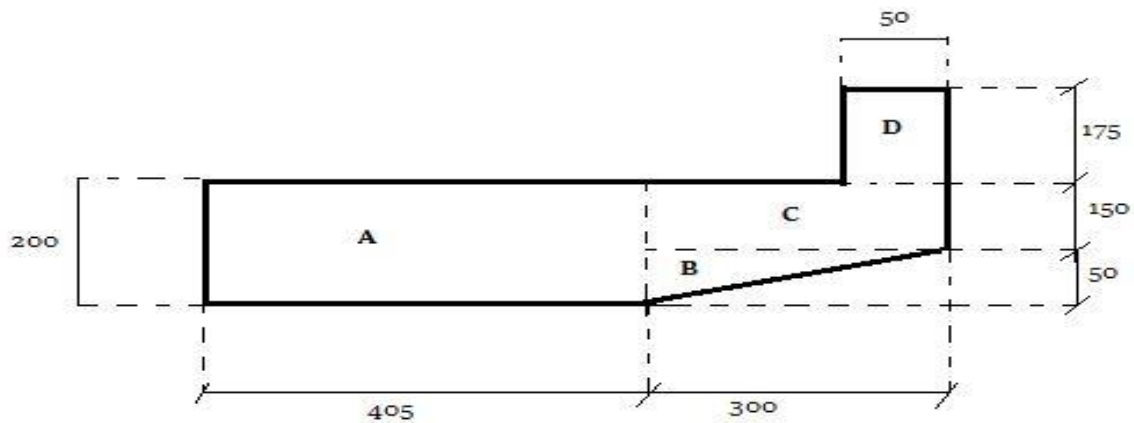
coupe transversale d'1/2 du chevêtre
